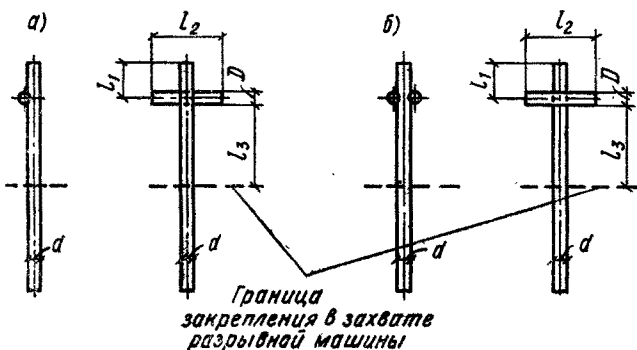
Контрольные образцы сварных крестообразных соединений для испытания на срез
